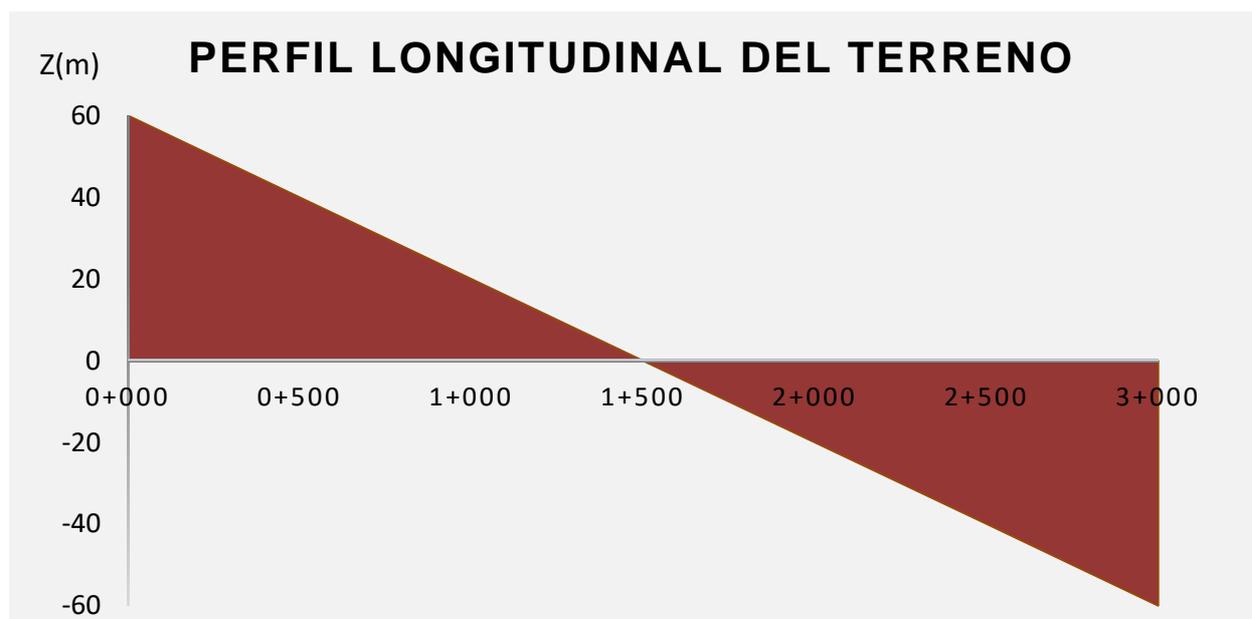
Perfil longitudinal de terreno. Problema propuesto nº3
